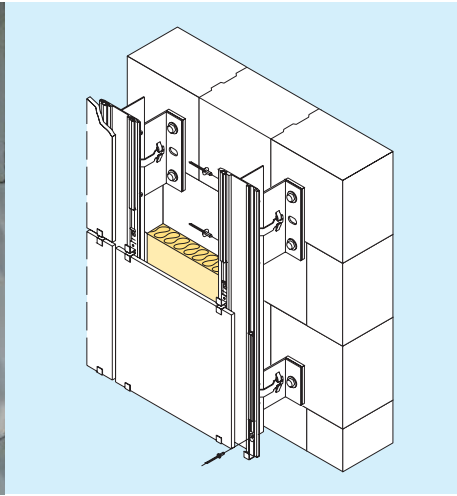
Vorgehängte hinterlüftete Fassaden mit Aluminium-Unterkonstruktion
